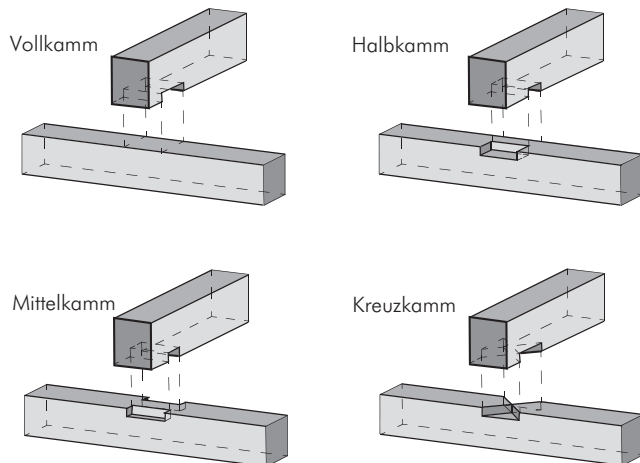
E.3 Explosionszeichnungen häufiger Kammarten.
